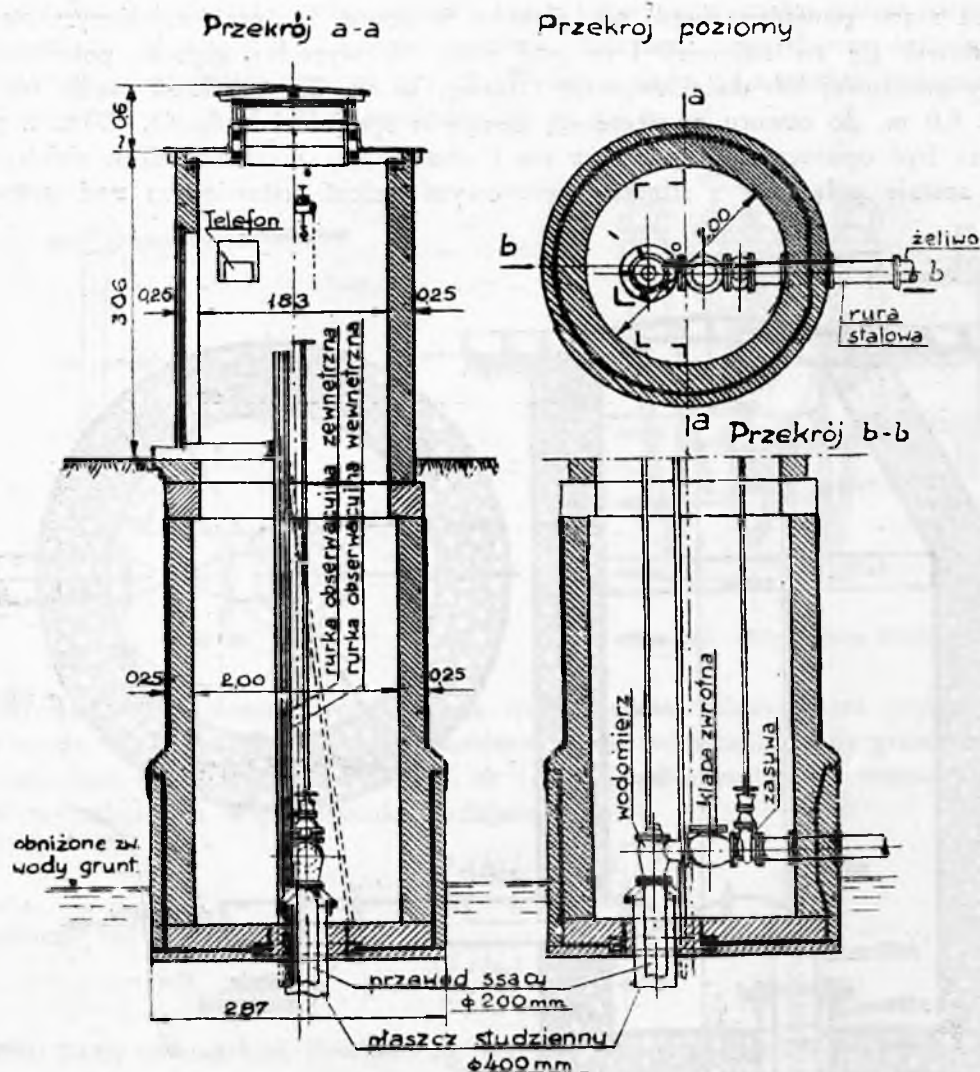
Obudowa studni Nr 1 w Łowiczu.
